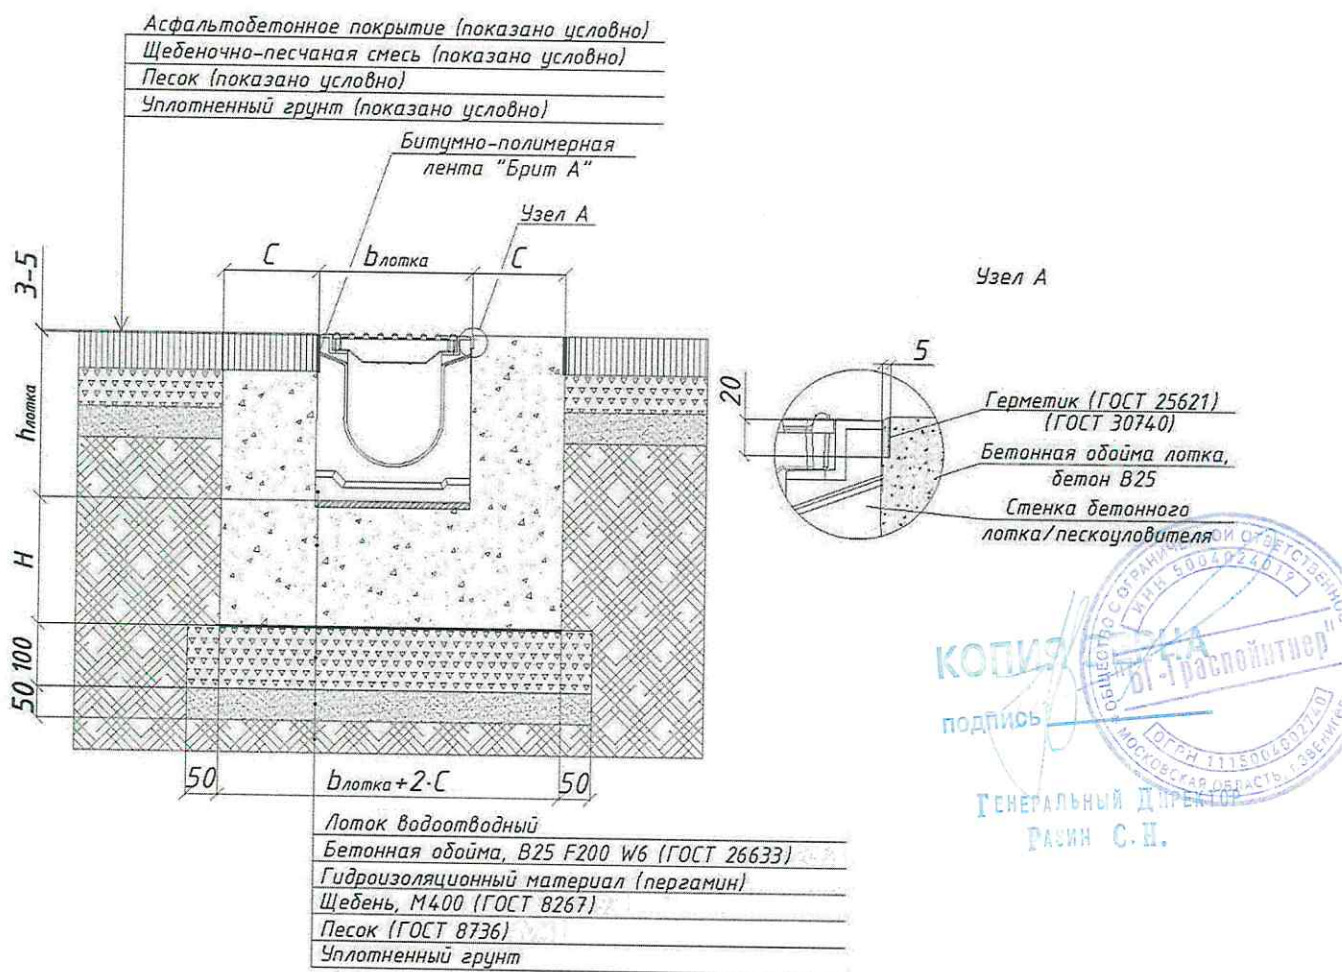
Схема монтажа лотка бетонного водоотводного
